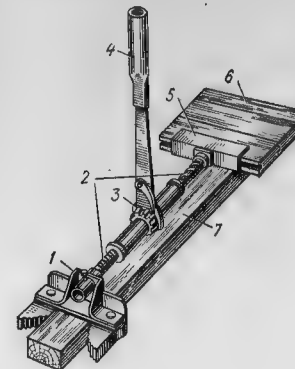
1 — захват лаговый двухэксцентриковый; 2 — винты выдвигаемые; 3 — устройство храповое; 4 — рукоятка; 5 — упор; 6 — доски; 7 — лаги
